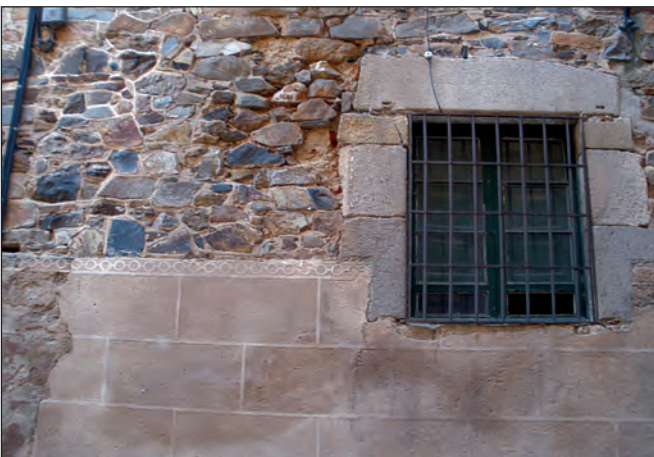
Edificio de la Calle Ancha de Cáceres. Ejemplo de degrado de un muro de mampostería vista.
